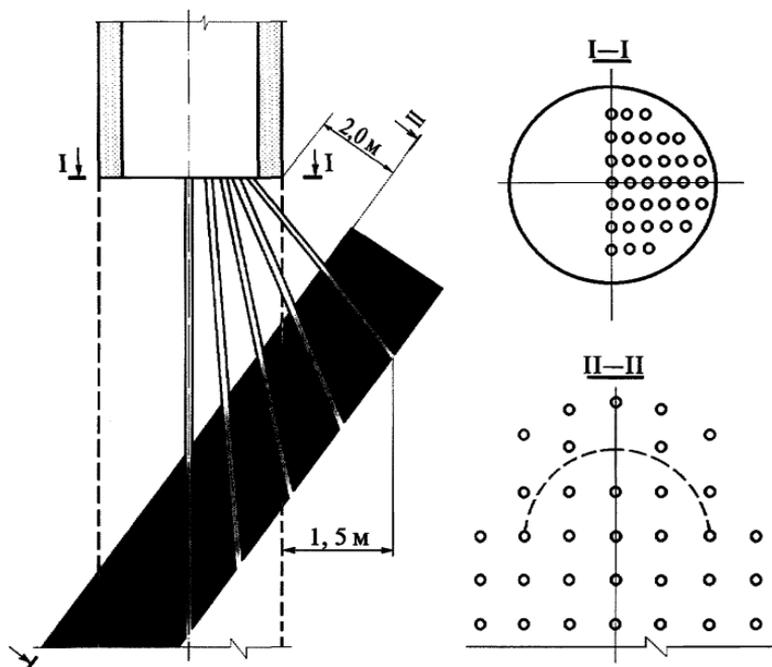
Схема расположения дренажных скважин при вскрытии угольных пластов кругого залегания
